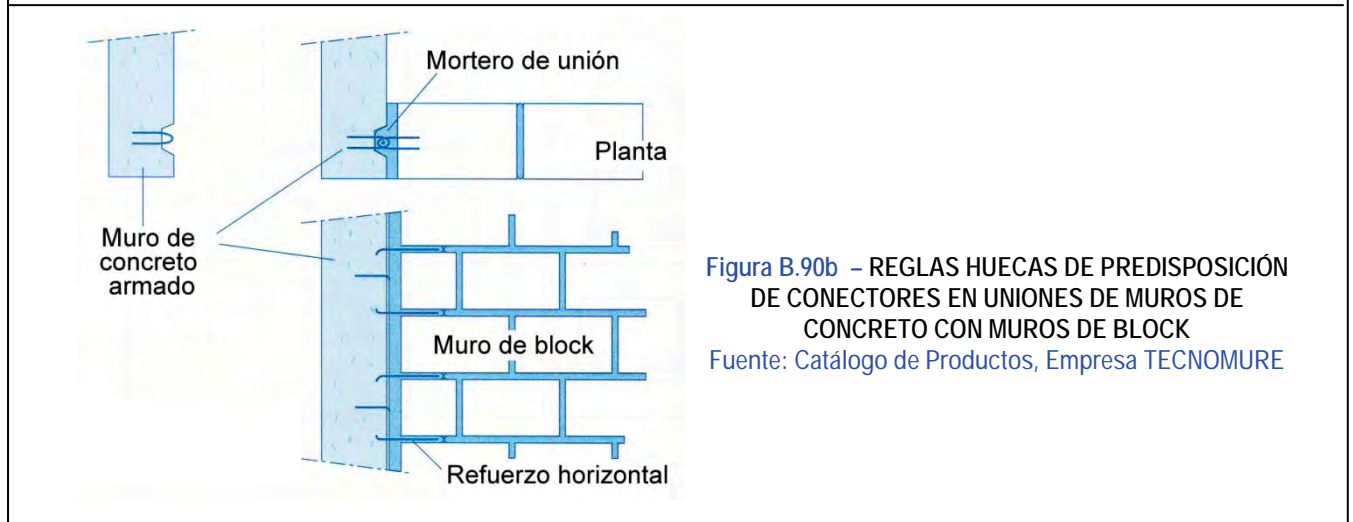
REGLAS HUECAS DE PREDISPOSICIÓN DE CONECTORES EN UNIONES DE MUROS DE CONCRETO CON MUROS DE BLOCK
